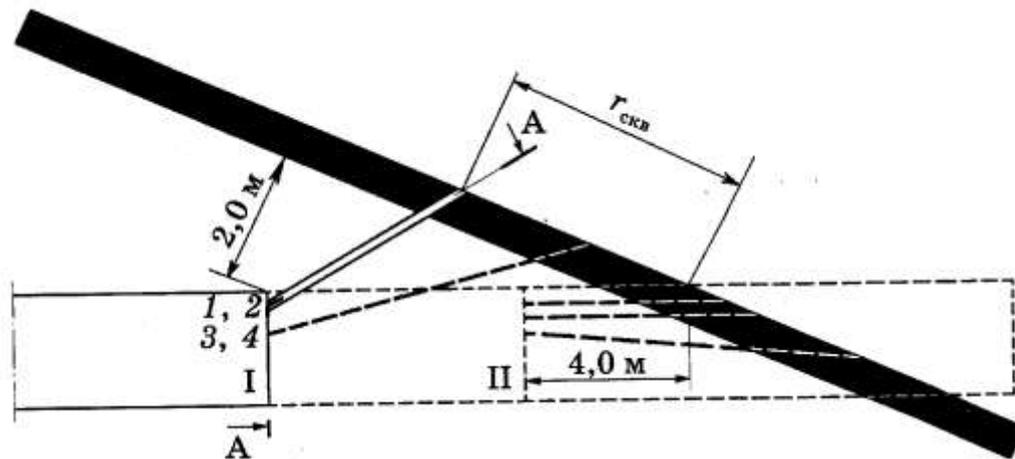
Схема расположения скважин для гидрообработки угольного массива перед вскрытием крутого пласта:
